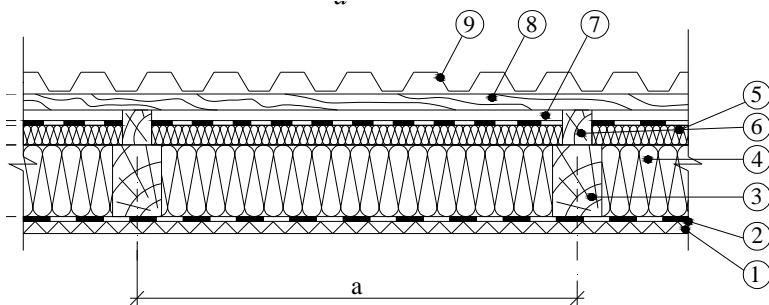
Схема «3». Вариант конструктивного решения устройства теплоизоляционного слоя и подкровельных пленок в конструкции покрытия. Утеплитель разделен на две части. Стропила изолированы сверху
